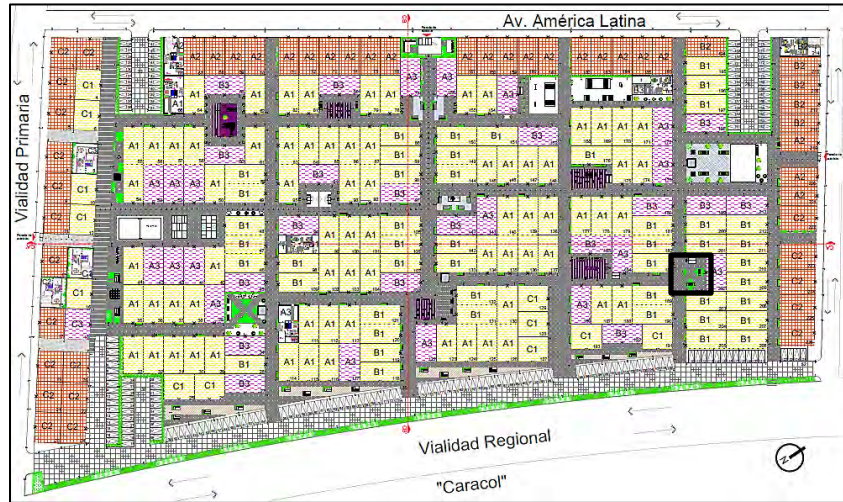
Plano de conjunto. Señalado con un marco negro la ubicación de la plaza 8.
